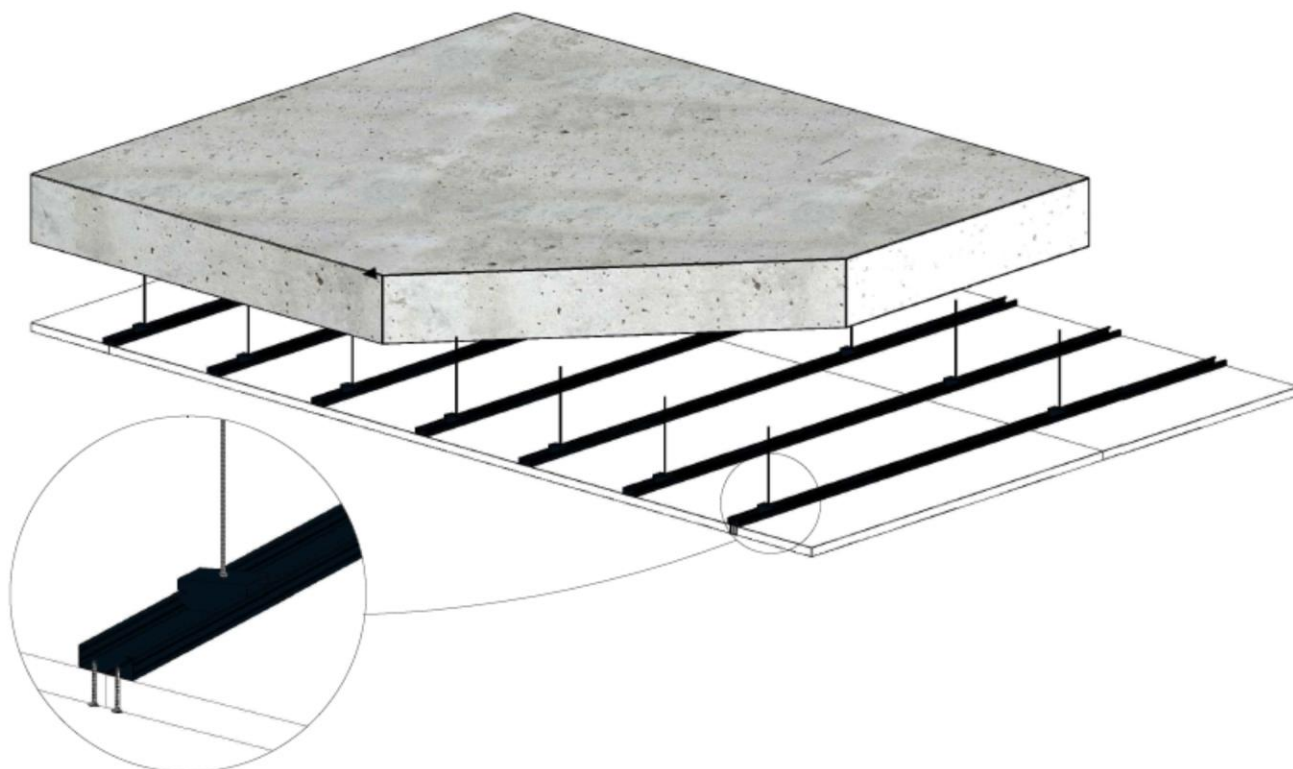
Plafond intérieur HydroProof®-Exemple avec suspente pivot
